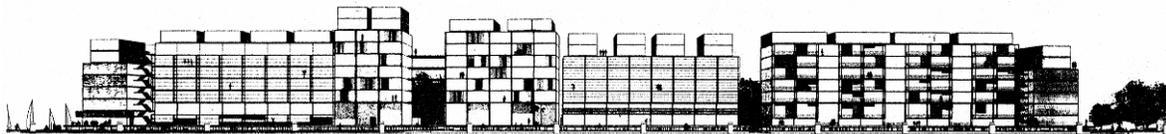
Fachada do conjunto vista do Rio Zaan.
